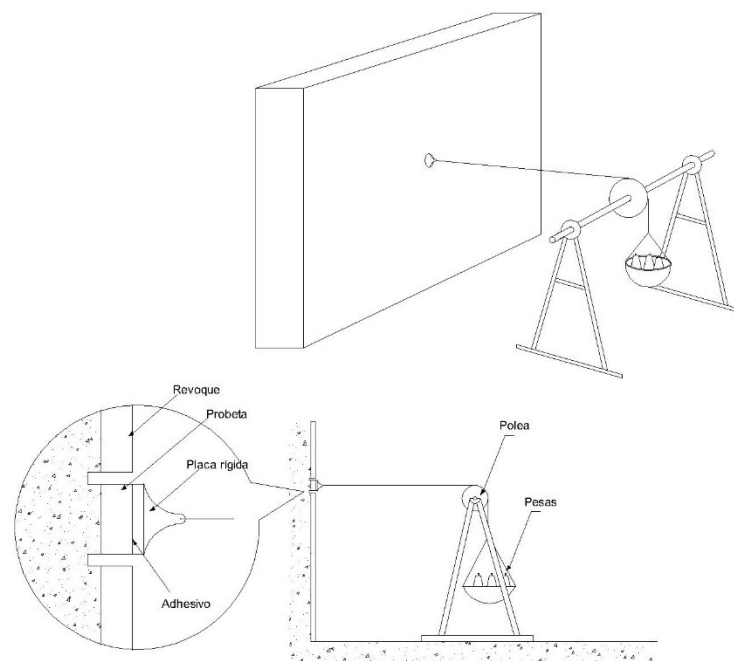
Dispositivo para aplicar la carga durante el ensayo de arrancamiento.
